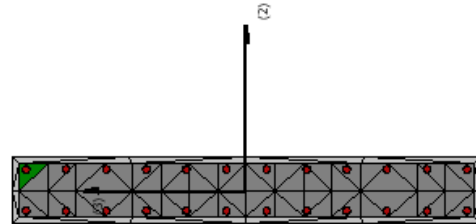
Discretización de fibra distribuida en sección de muro de hormigón armado, SeimoStruct.
